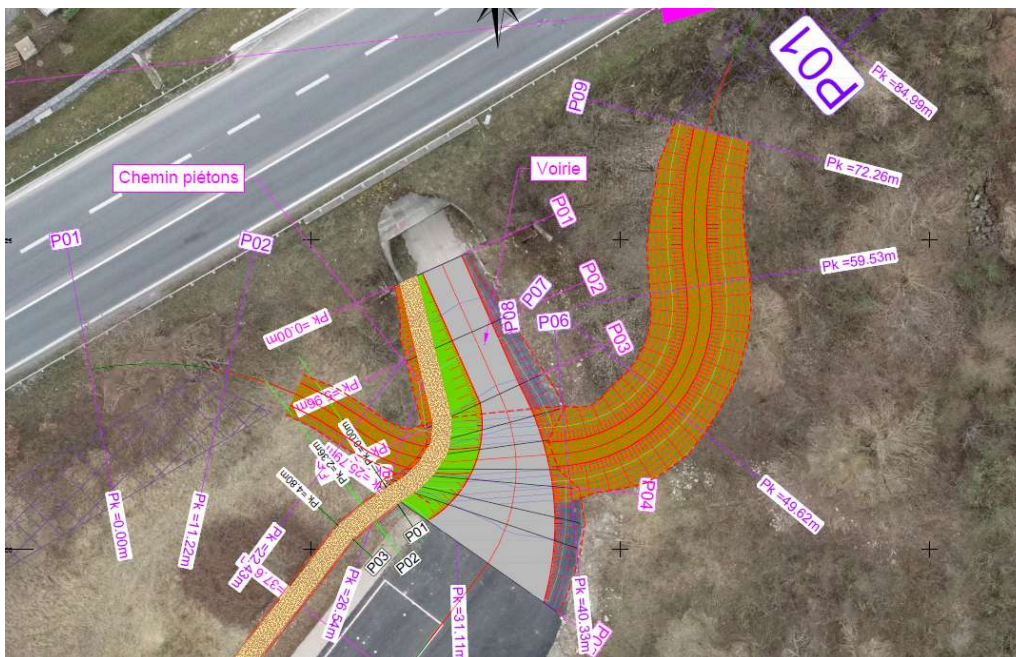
Vue en plan du merlon de protection (source : GUINTOLI)
